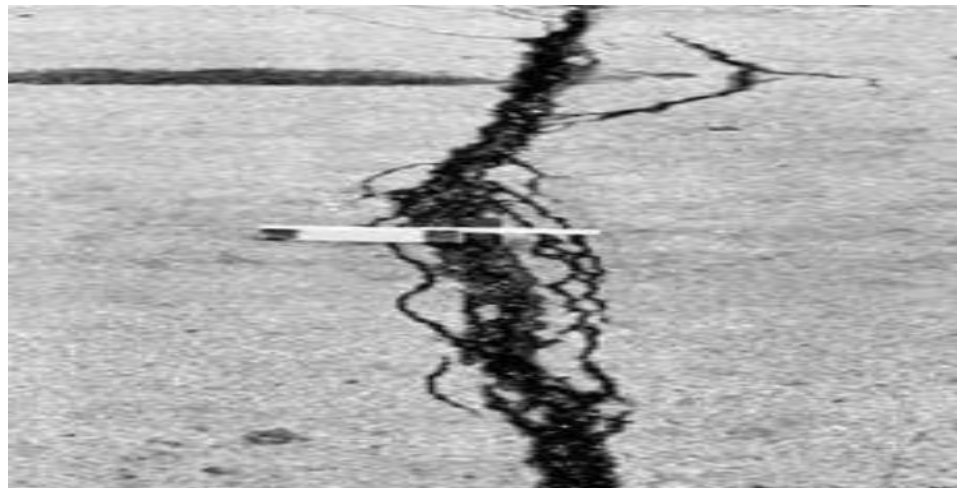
Fisuras de reflexión de junta – Alta severidad.
